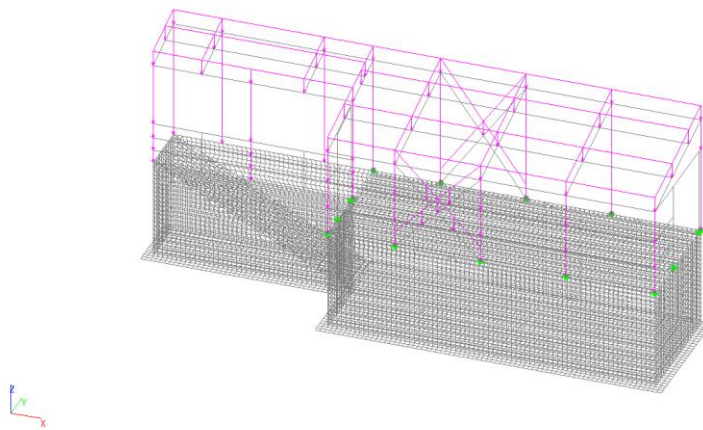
Расчетная модель монолитной лестницы по грунту, загруженная снеговой нагрузкой (вариант №2)
